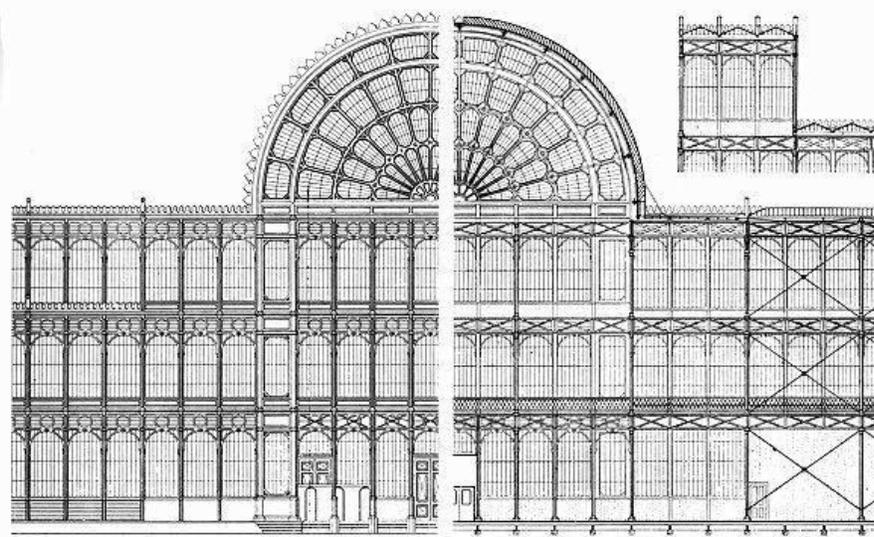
Projeto da fachada do Palácio de Cristal – 1851
